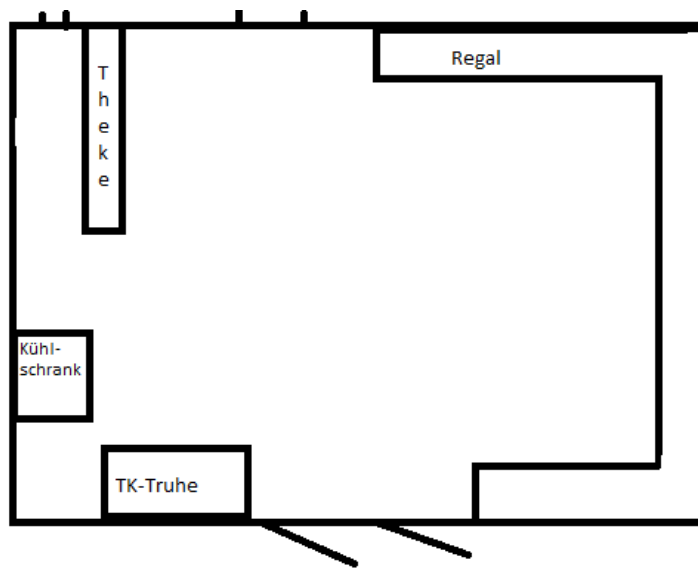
Geplanter Grundriss der Geschäftsstelle.
